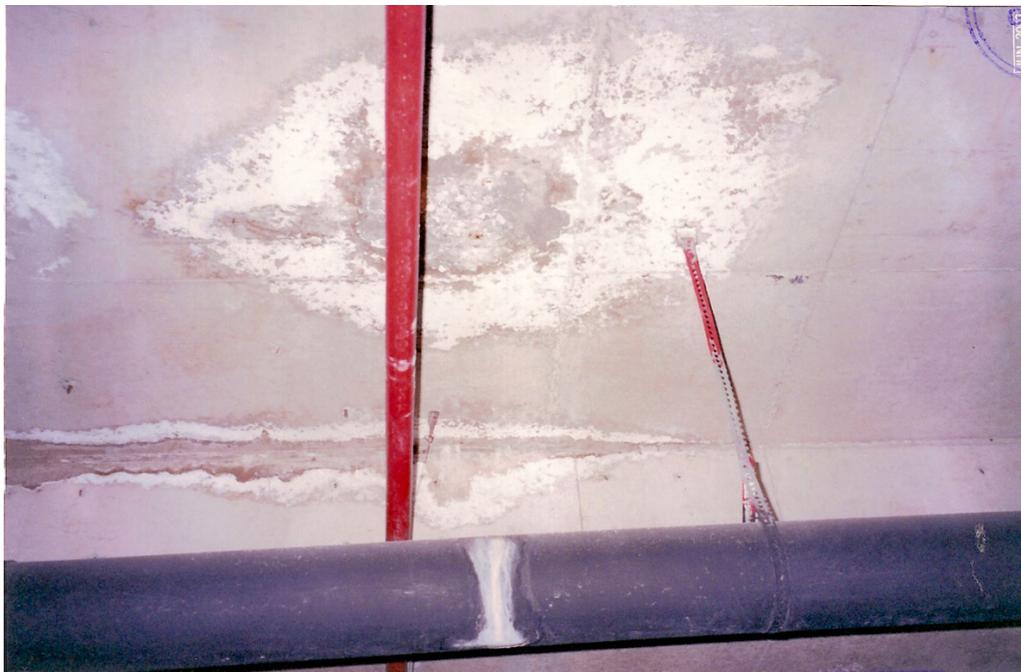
Vista de uma laje térrea com eflorescência devido ao processo de lixiviação, devido à falha na impermeabilização. (Neville, 1997)
